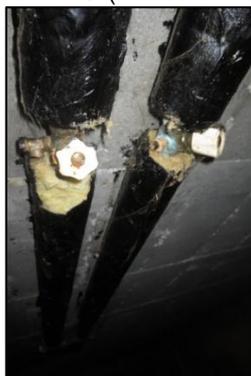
ECH-45 CALORIFUGEAGE -3 rue Calmette-Vide Sanitaire\_3 rue Calmette Gains & coffres horizontaux Laine minérale + enveloppe bituminée
